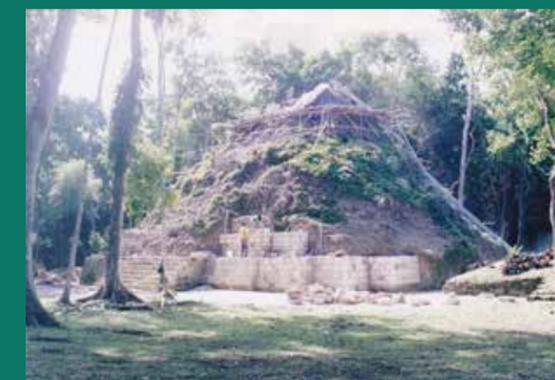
Edificio 1. Esquina noreste, fachadas este y norte, andamiaje de restauración cámara superior, integración de fachada de piedra y núcleo original en primer cuerpo y parte baja de escalinata central. Foto: TLCM 2002
